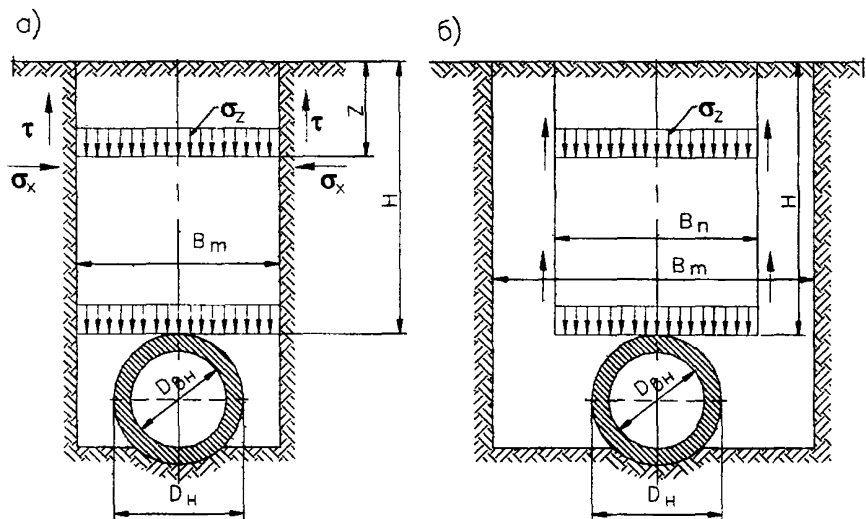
Схемы к расчету нагрузки на трубу от засыпки грунта в траншее:
